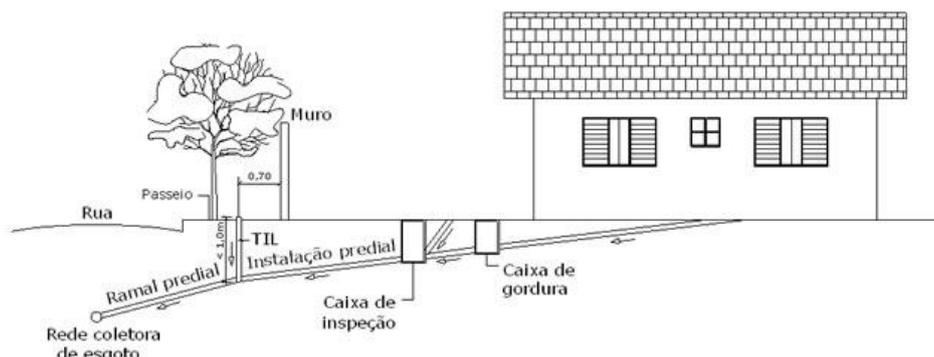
Esquema de ligação predial de esgoto sanitário.
